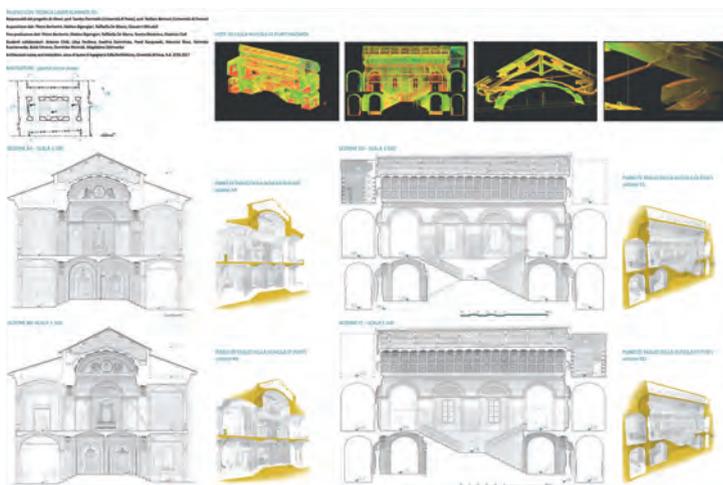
Rilievo geometrico digitale con tecnica laser scanner 3D
